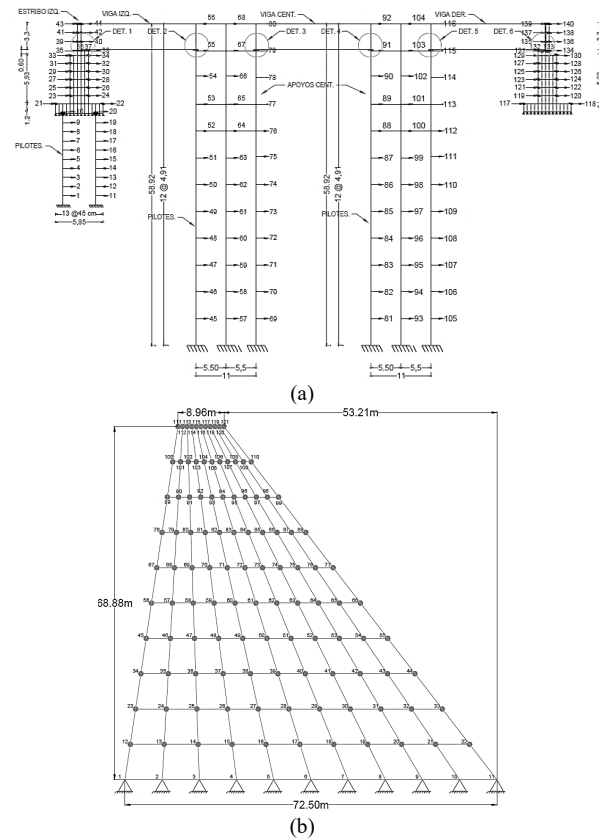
Estructuras modeladas con CEINCI-LAB, a) Puente; b) Presa.
